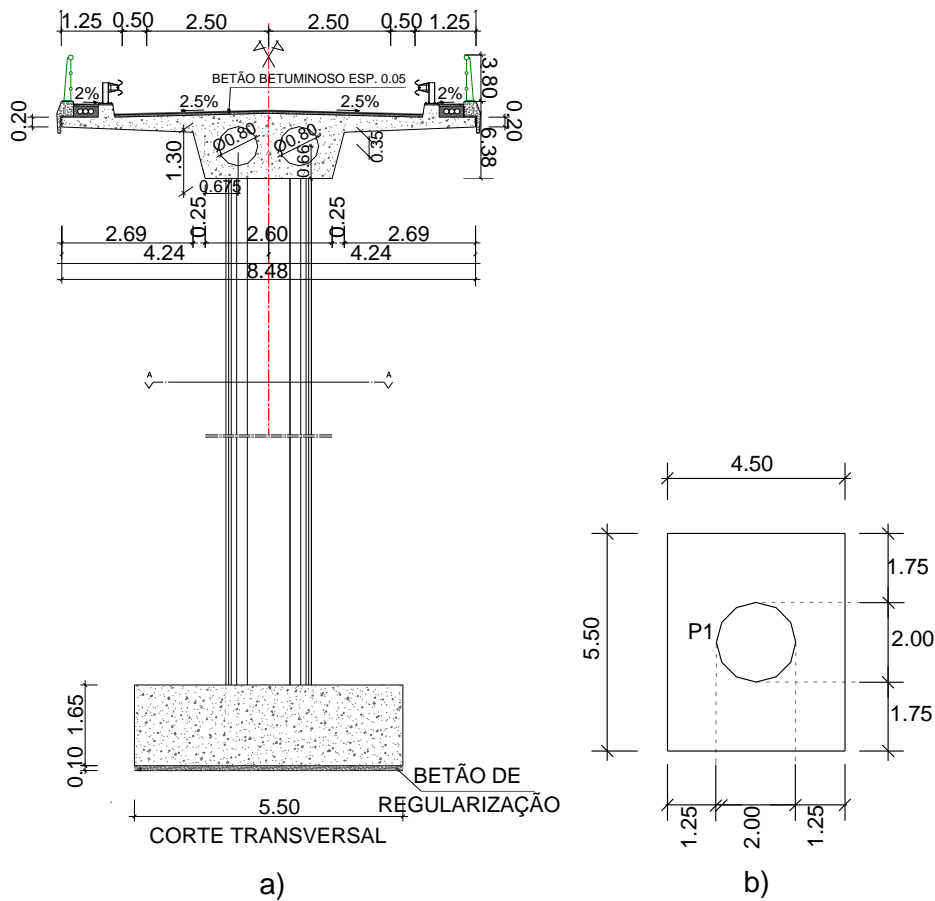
Secção transversal: a) Sapata, pilar e tabuleiro da estrutura; b) Fundação e pilar da estrutura
